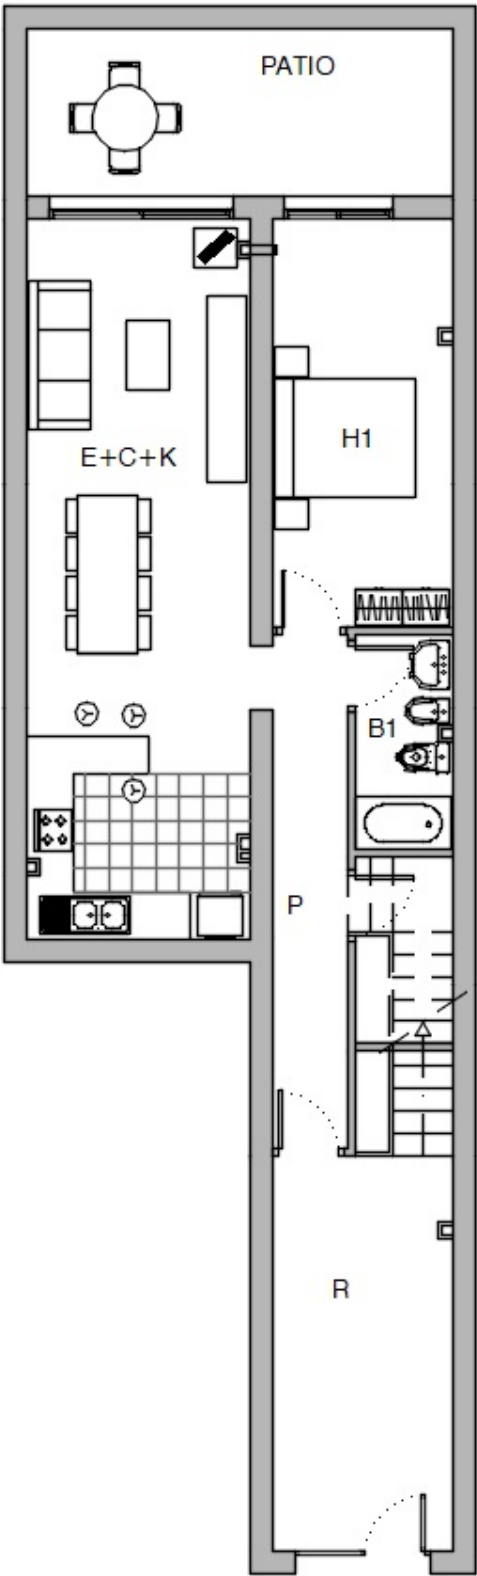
Distribución planta baja / imágenes 3D
